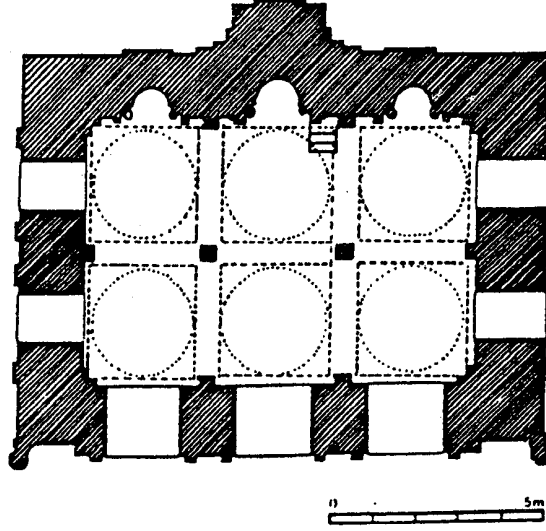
مسقط أفقي لجامع بيالي باشا في استانبول
